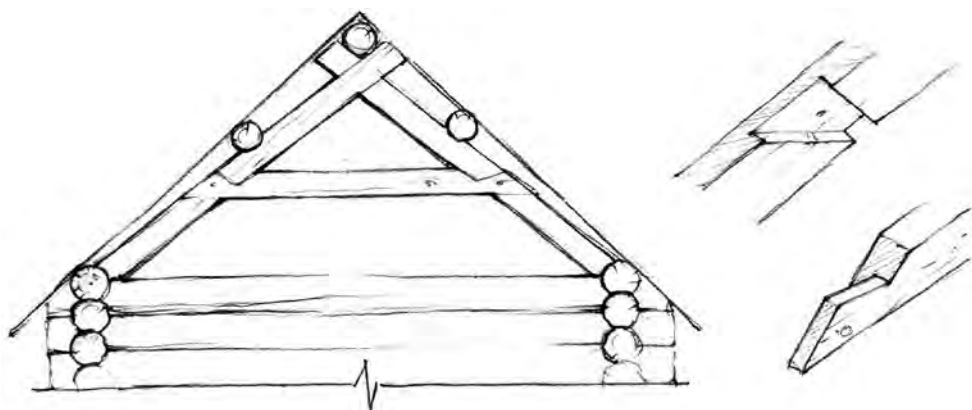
Конструкция двухскатного каркасного покрытия с затяжками
